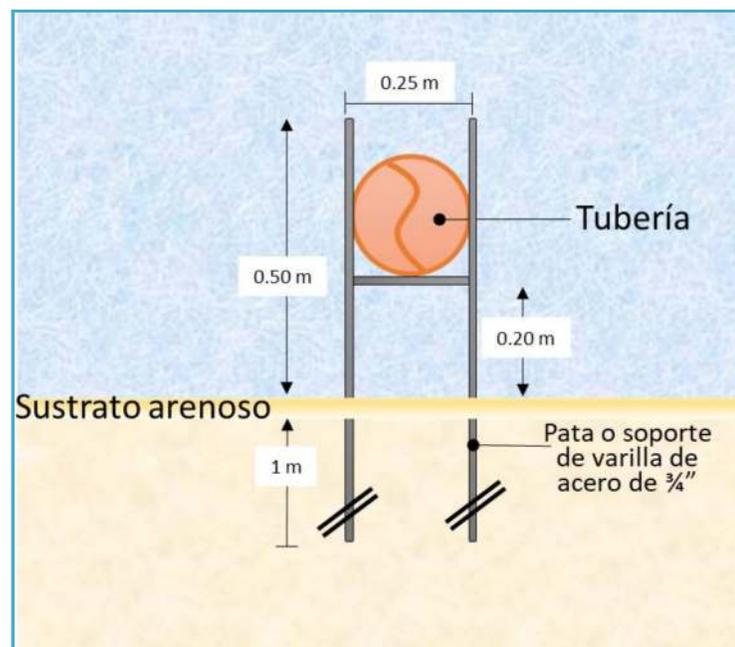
Esquema de las estructuras de soporte de la tubería de conducción de arena que su utilizarán en la zona de arenales con pastizal presente.
